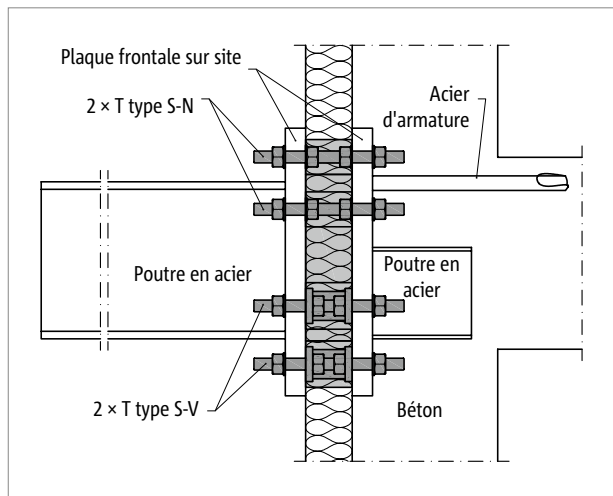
Schöck Isokorb® T type S-N et T type S-V : raccordement de structure en acier sur béton
